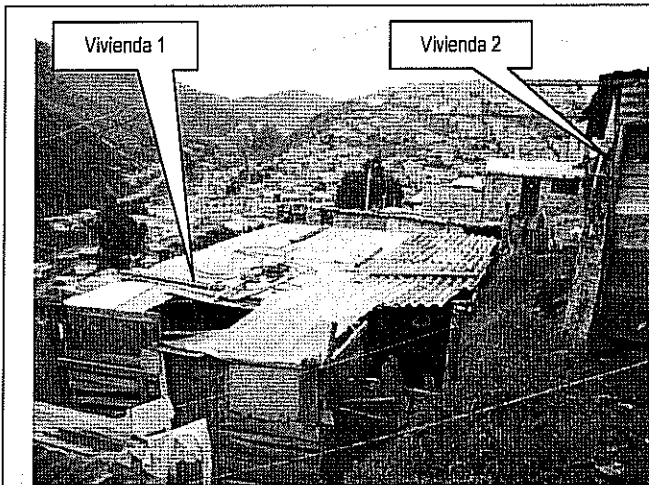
Vista general de fadera natural y distribución espacial de las viviendas evaluadas.
